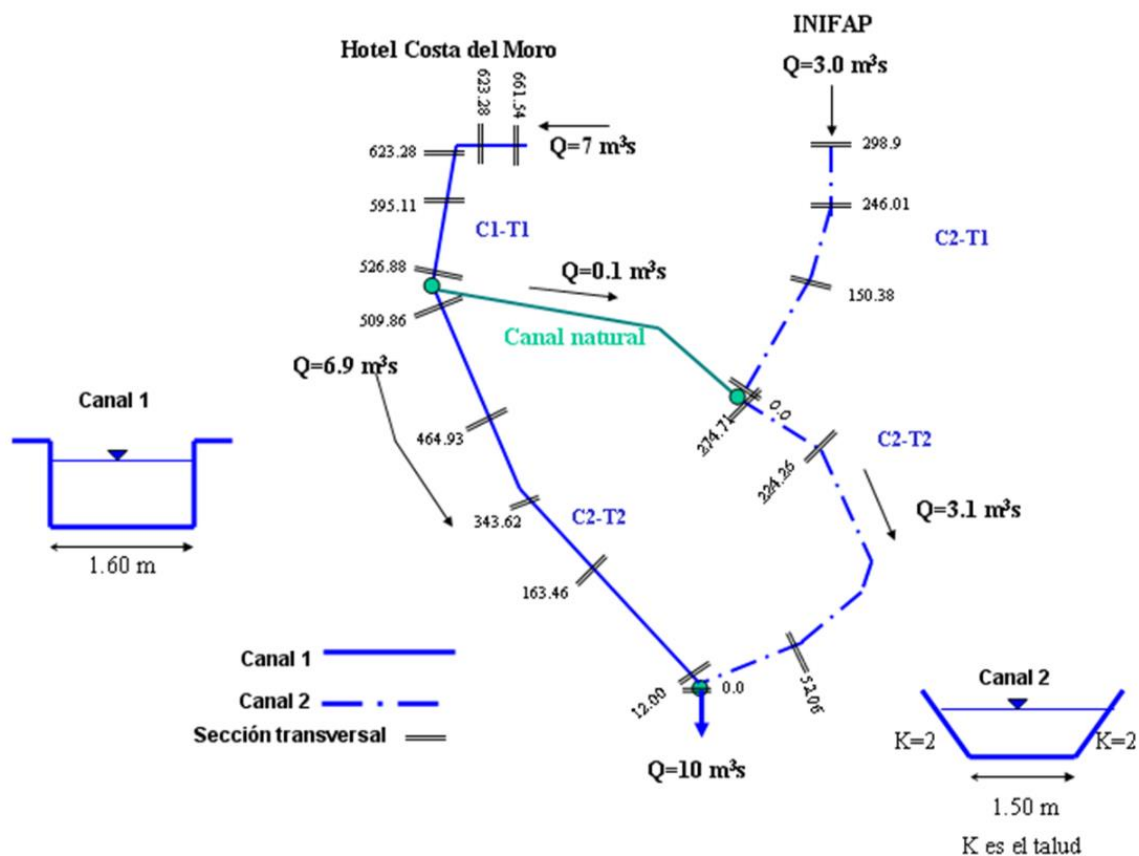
Esquema de la red de drenaje del proyecto y algunas secciones tipo
